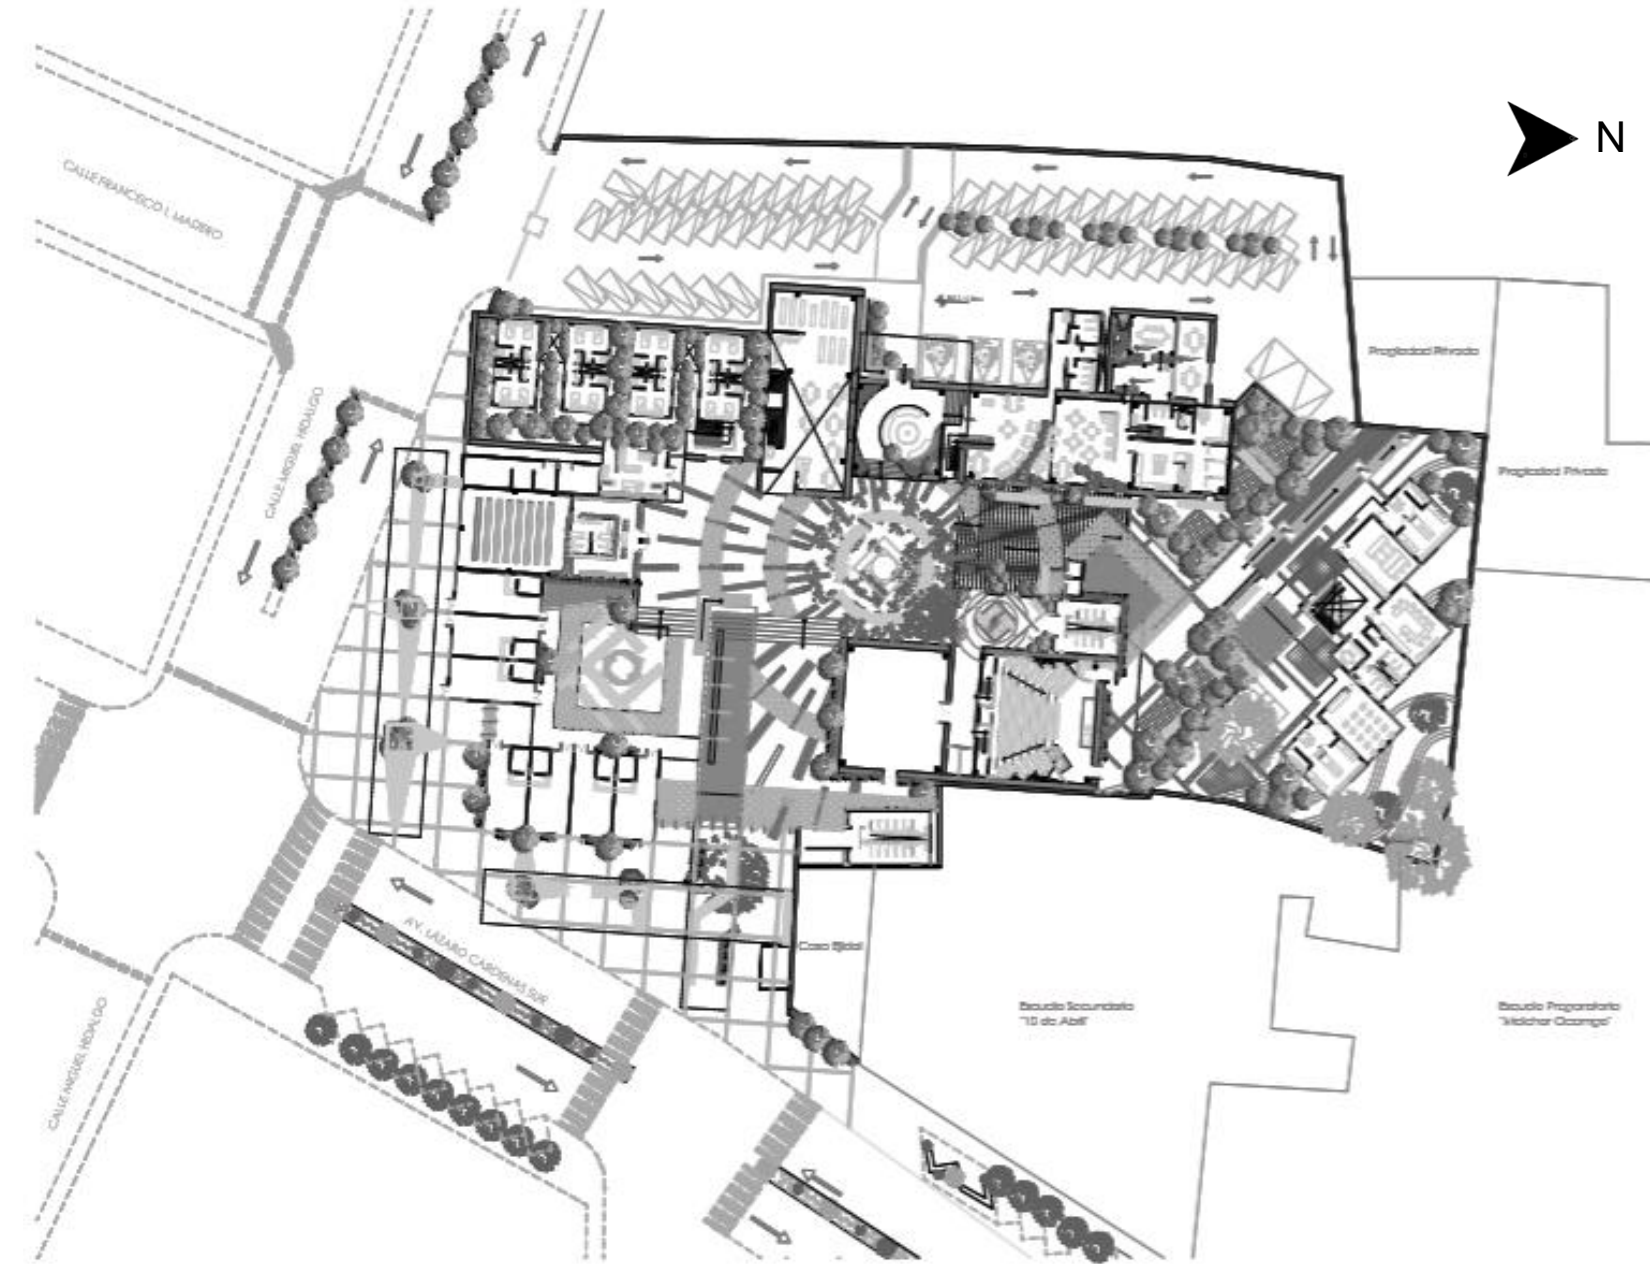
Planta arquitectónica de conjunto, Centro multidisciplinario Ex hacienda Cusi,
